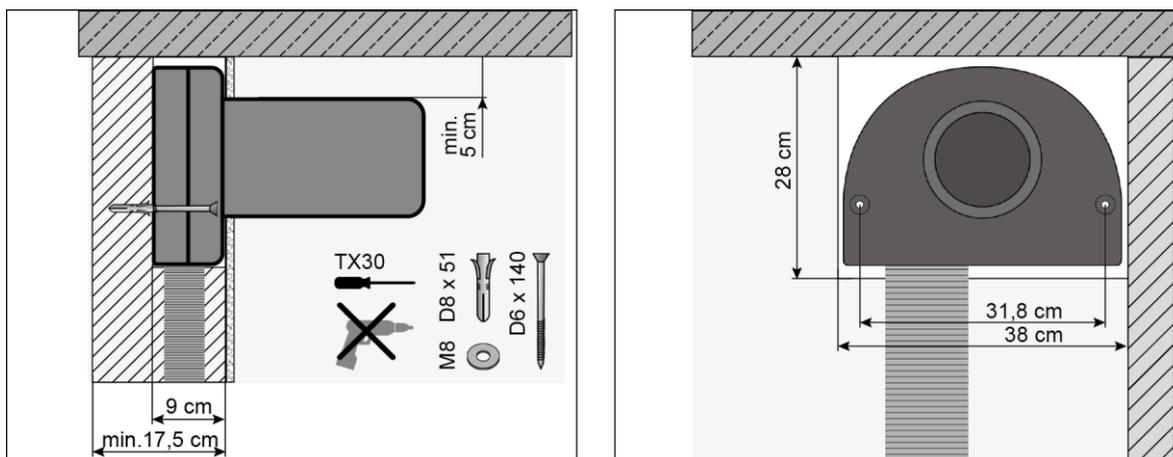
Montage mit Schrauben und Dübeln (Massivbauwand), Seiten- und Frontansicht
